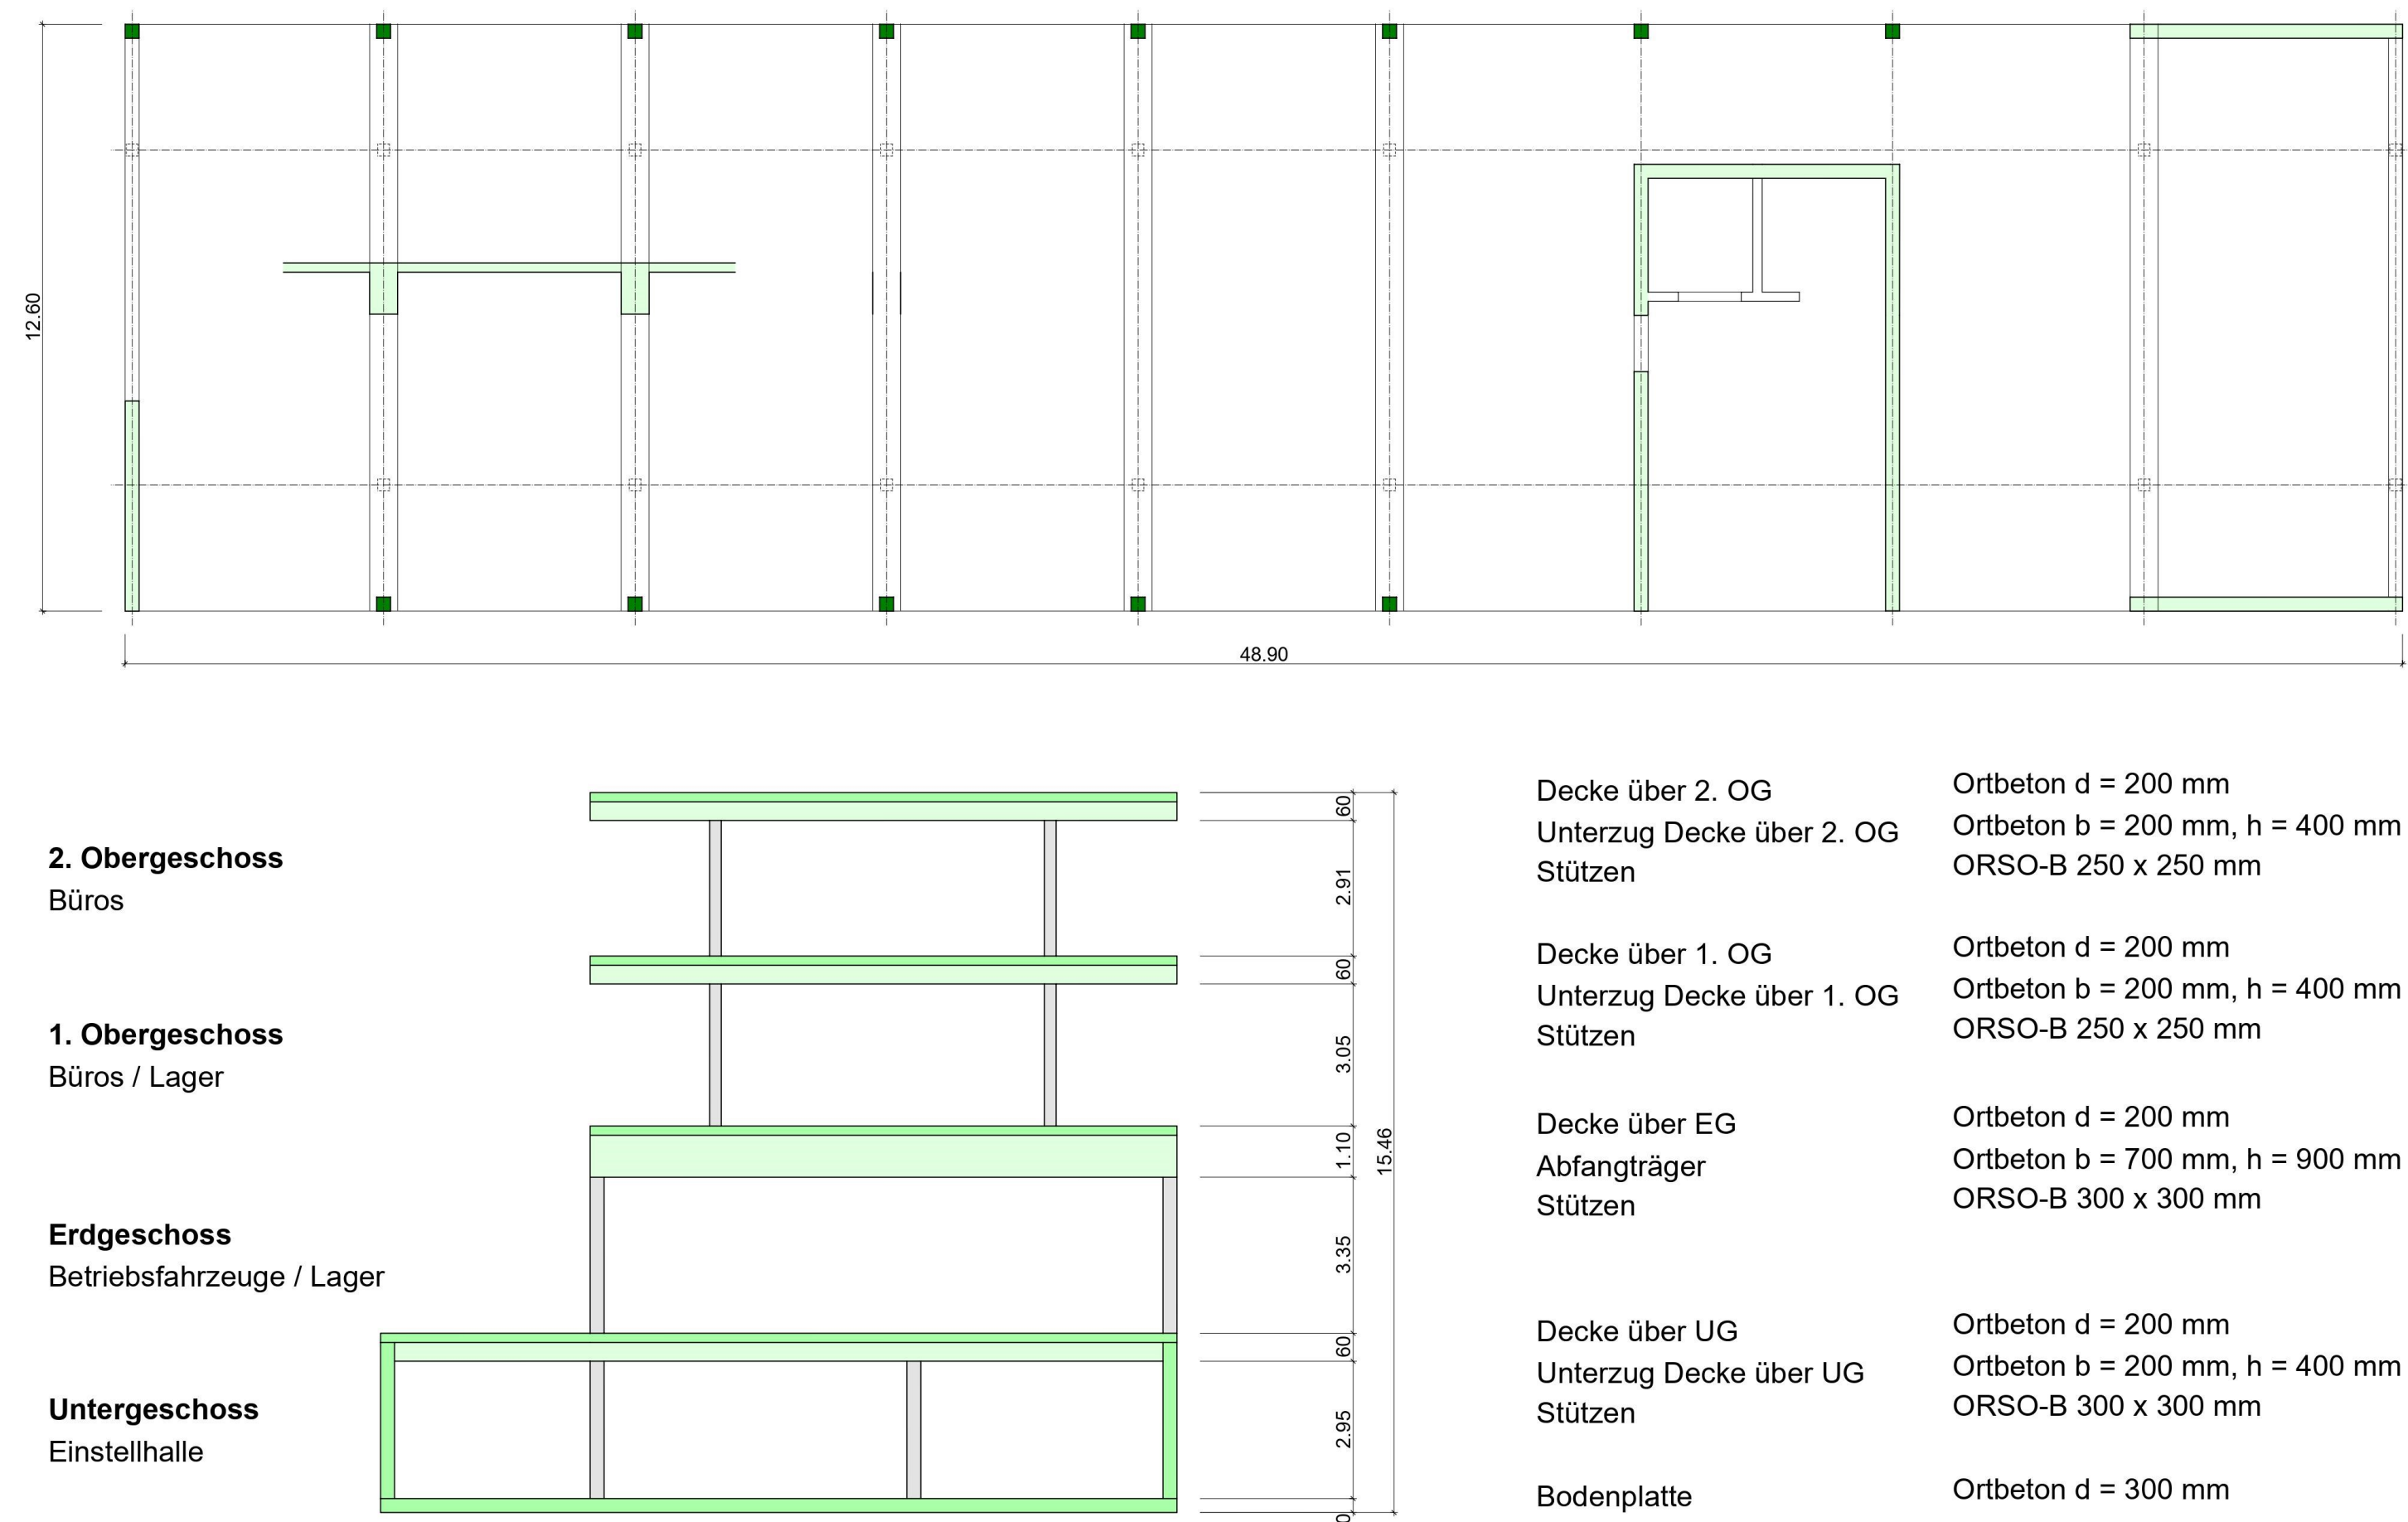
Grundriss und Schnitt durch das Tragwerk mit den wichtigsten Abmessungen (Eigene Darstellung)
